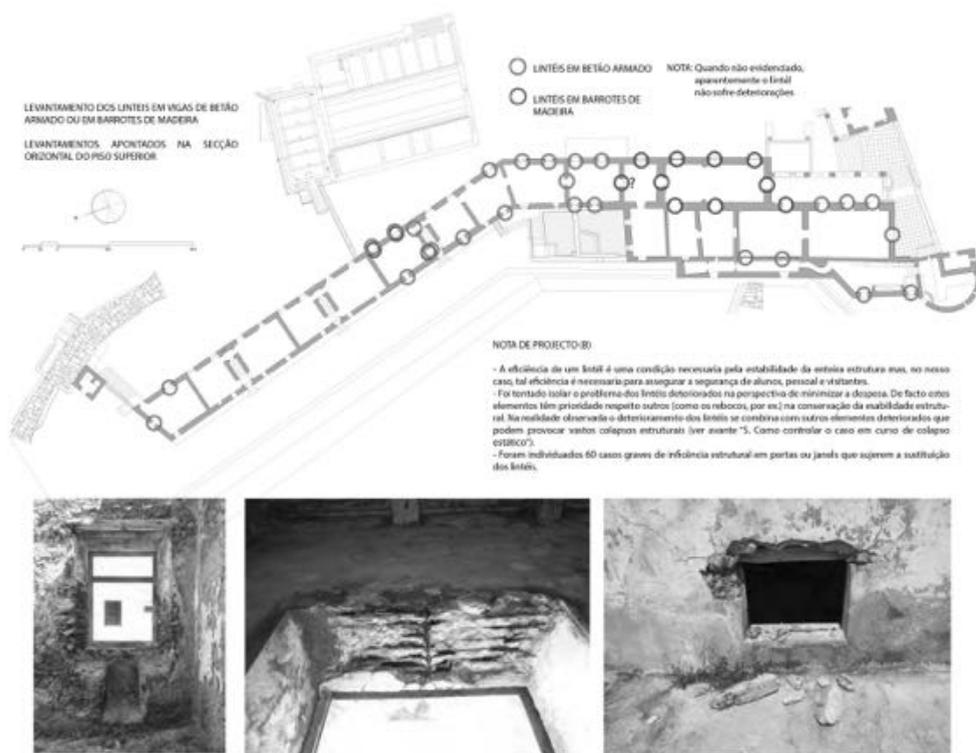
Levantamento dos lintéis de betão e de madeira. Piso terreo.
